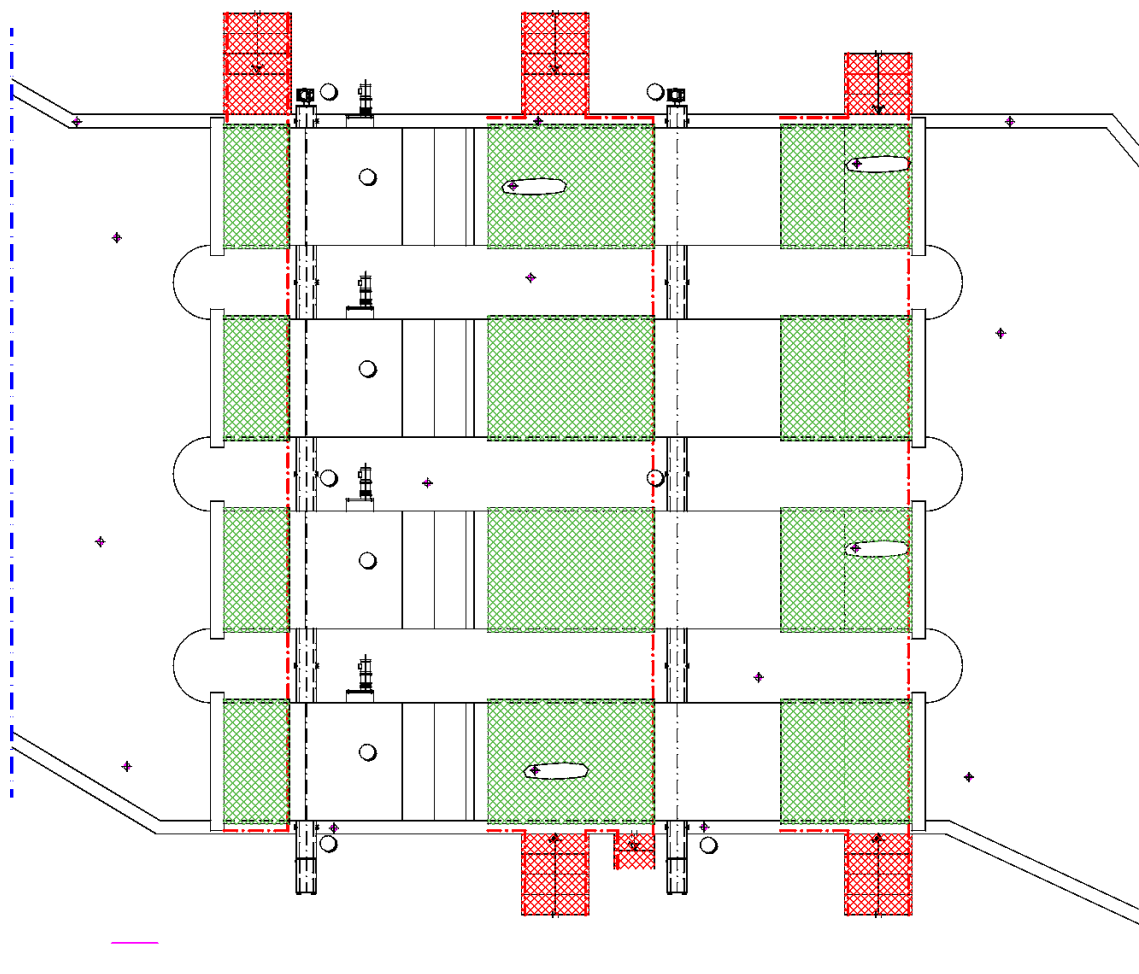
Plano en planta del desbaste de la EDAR Arroyo del Soto. Escala 1/75.
